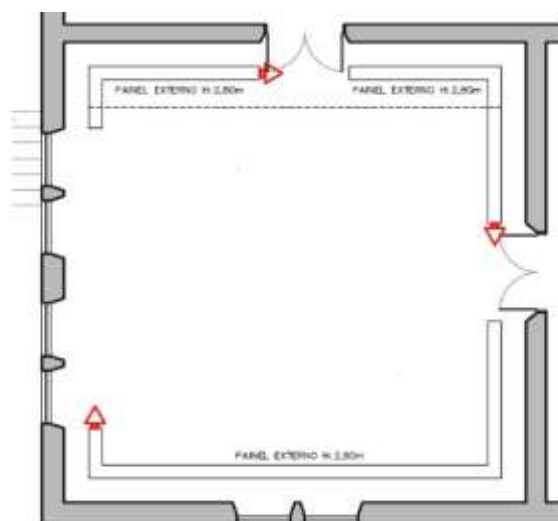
Planta Baixa Sala do Patrono Leopoldo Gotuzzo.
